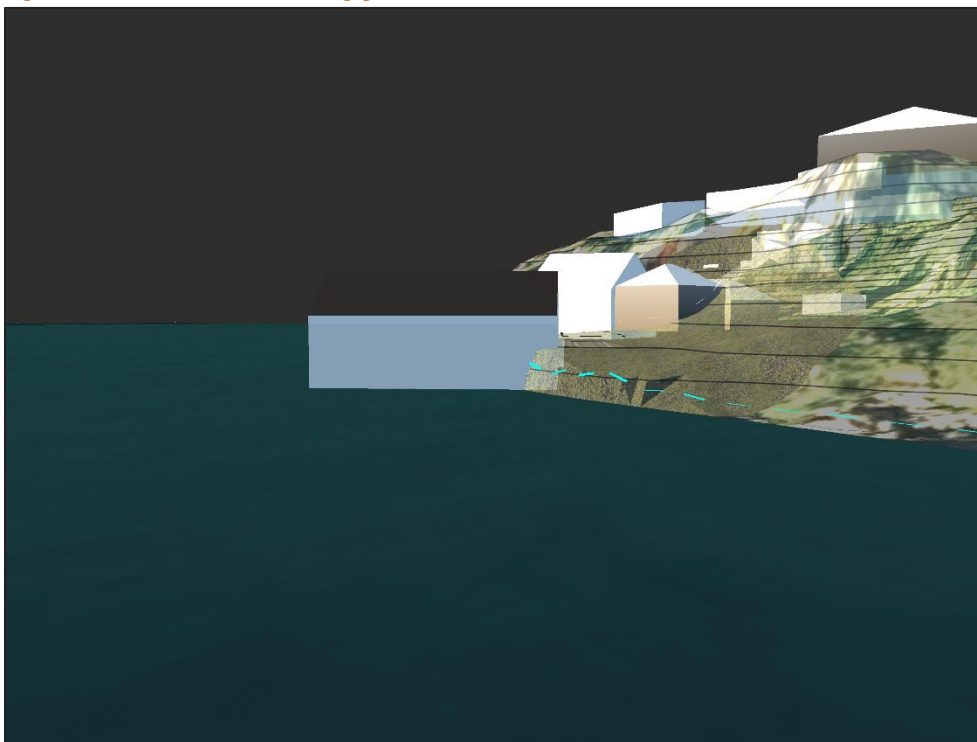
viser snitt hvor båttømen er plassert i tilknytning til bryggeanlegget for BUN1, lik figur 18.
